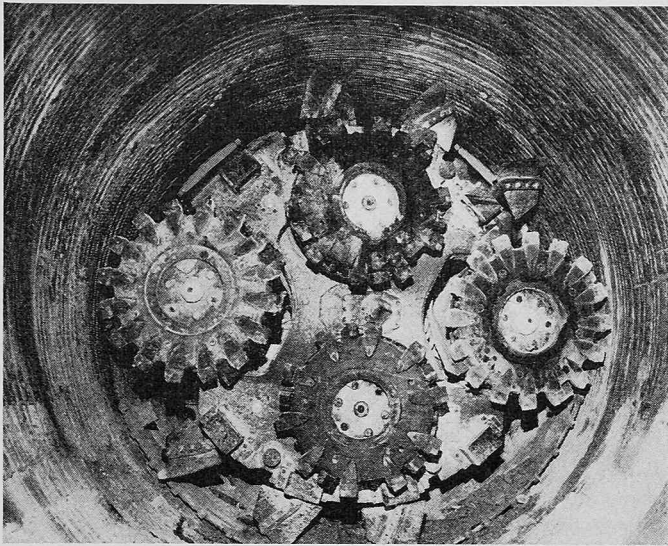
Angriffseite der Tunnelfräsmaschine Habegger
